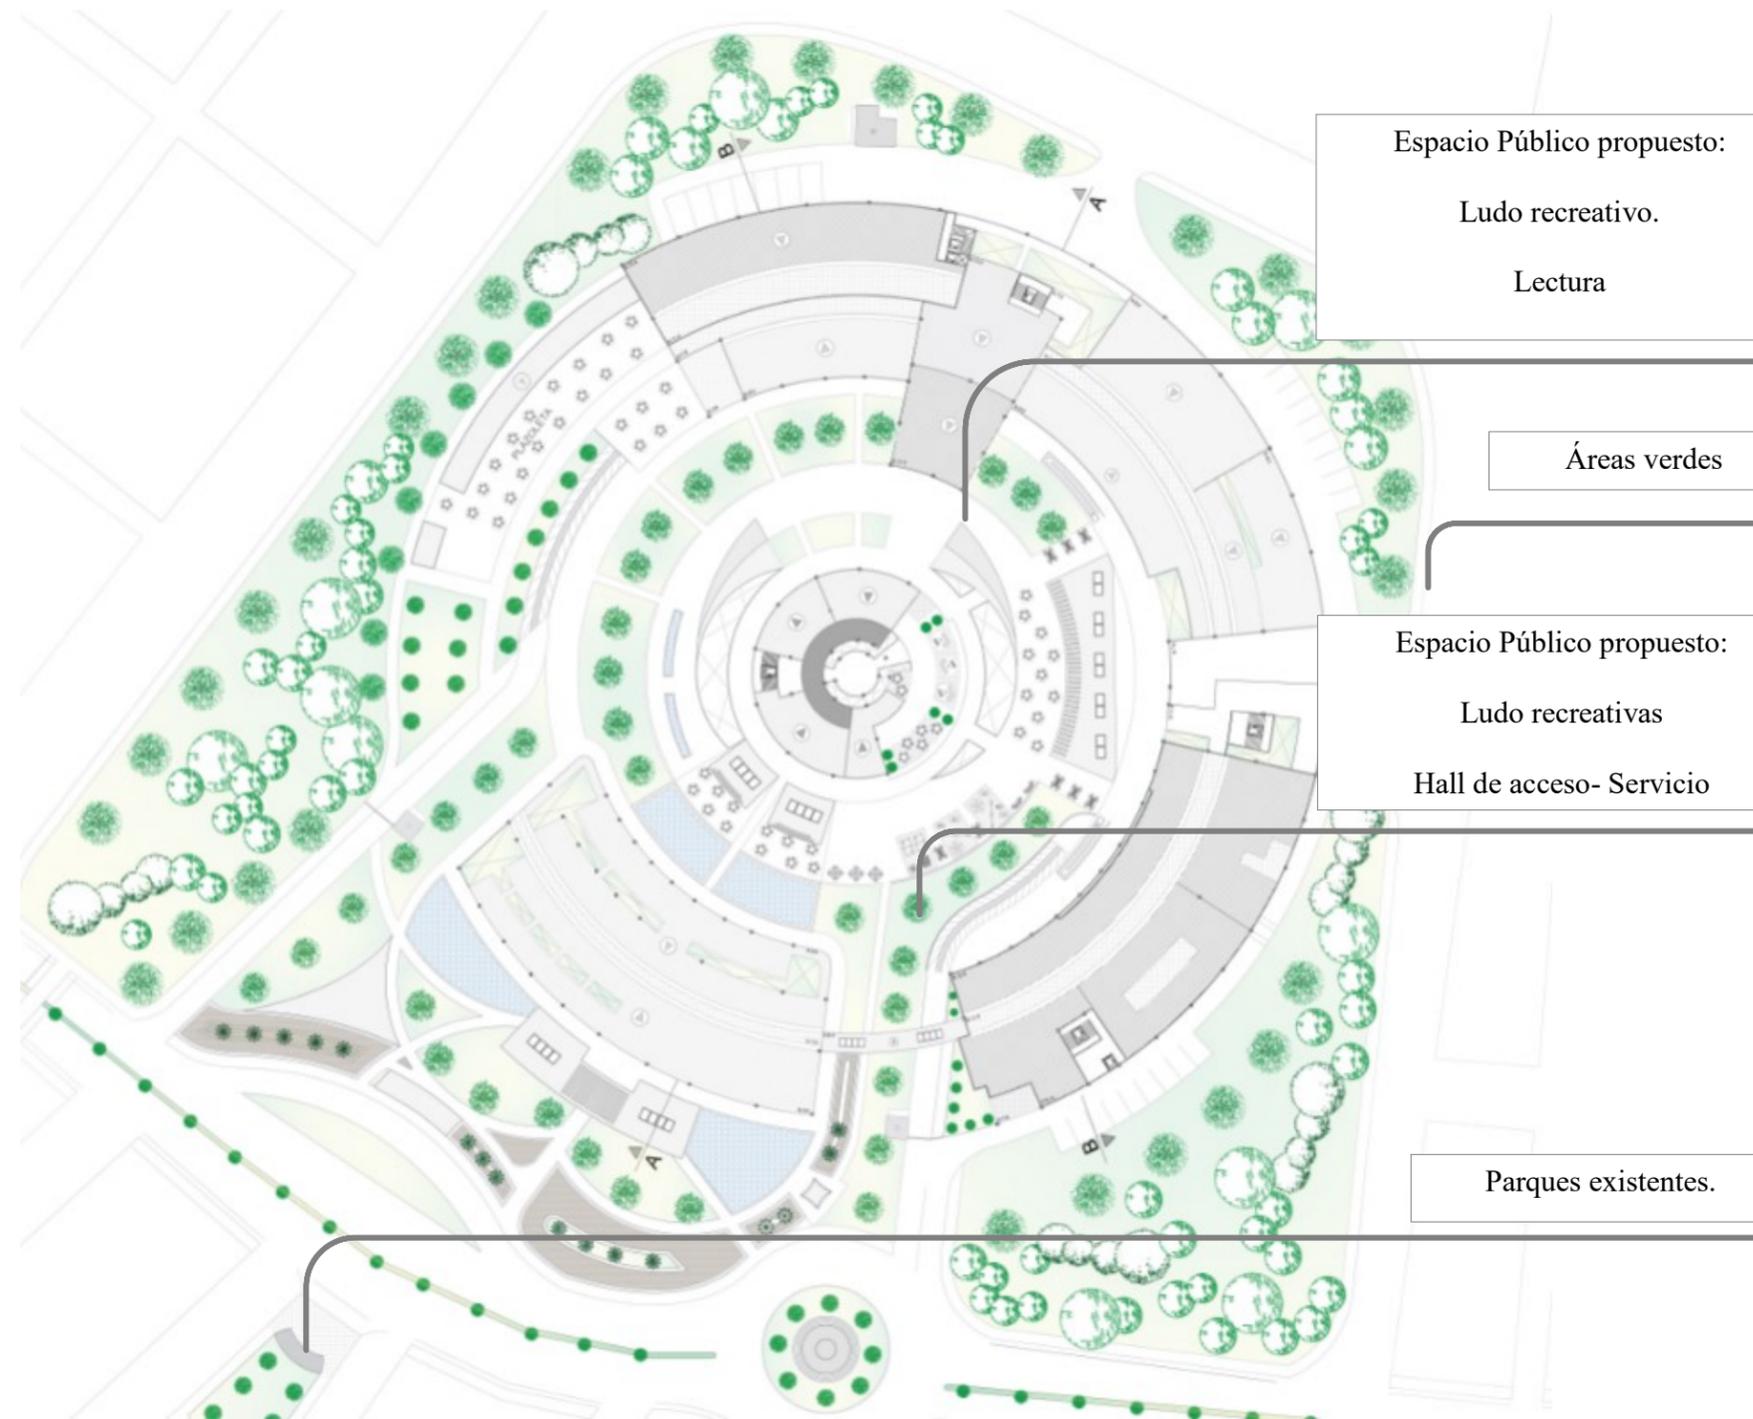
Planta Urbana sector. Fuente: Elaboración propia.
